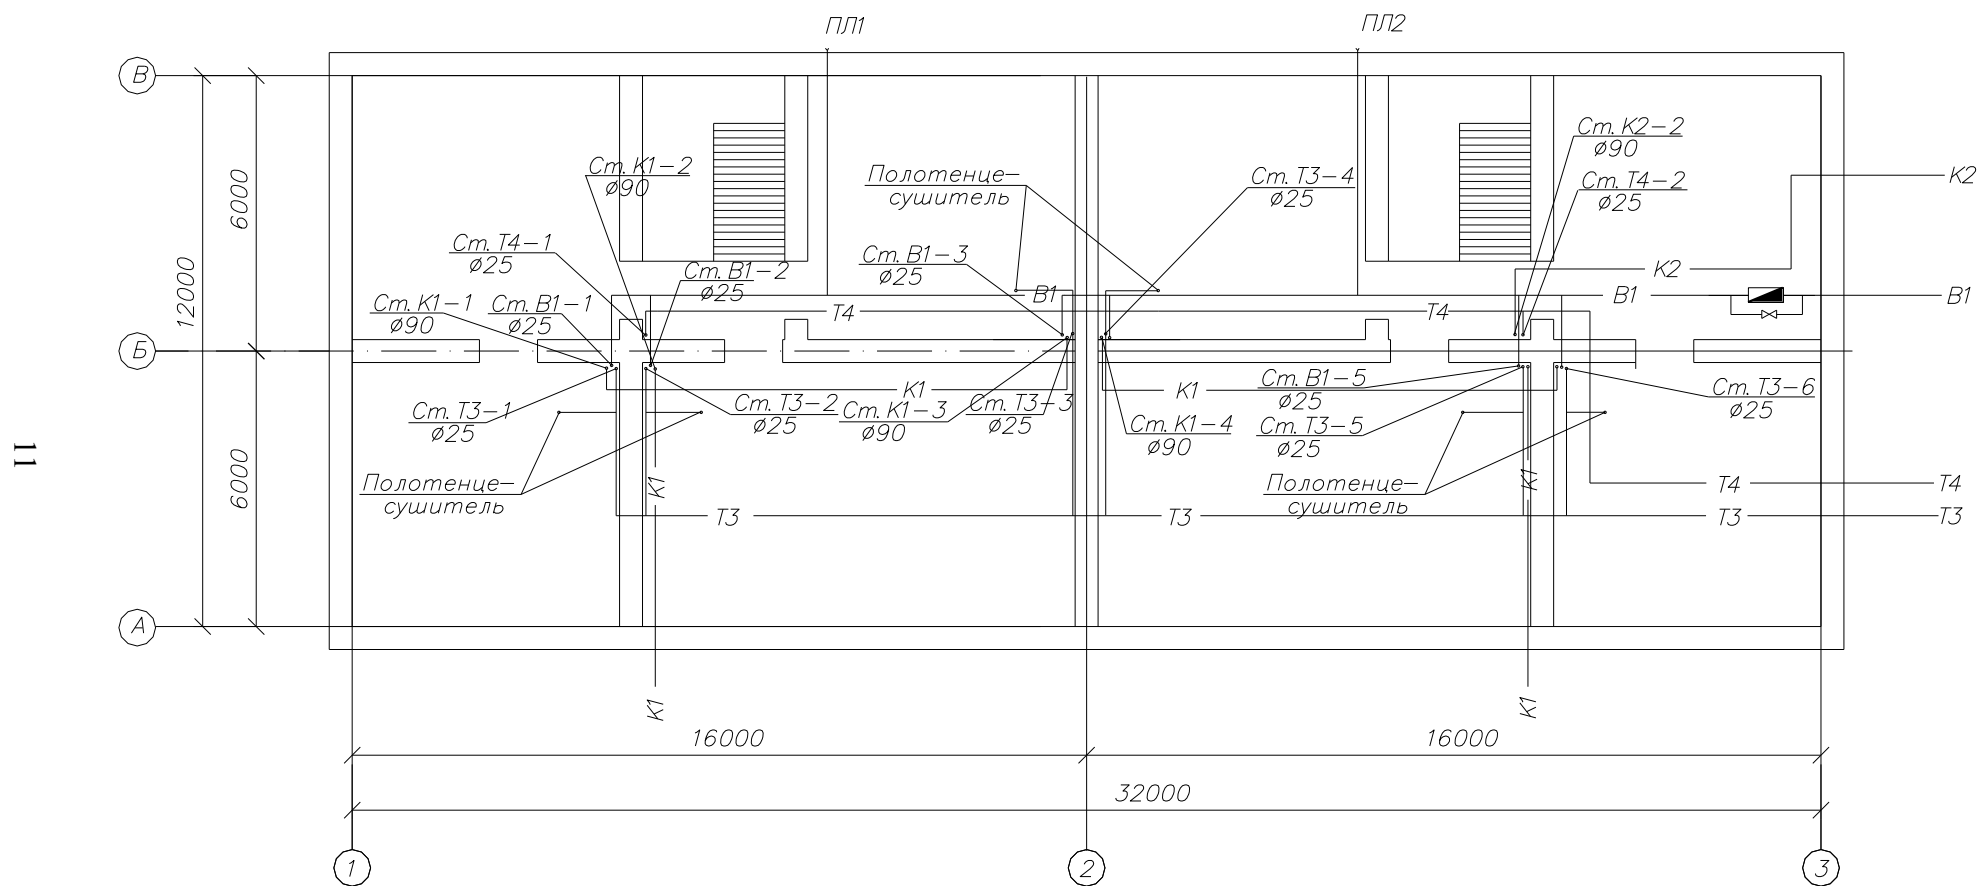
Трассировка трубопроводов на планах здания: подвал
